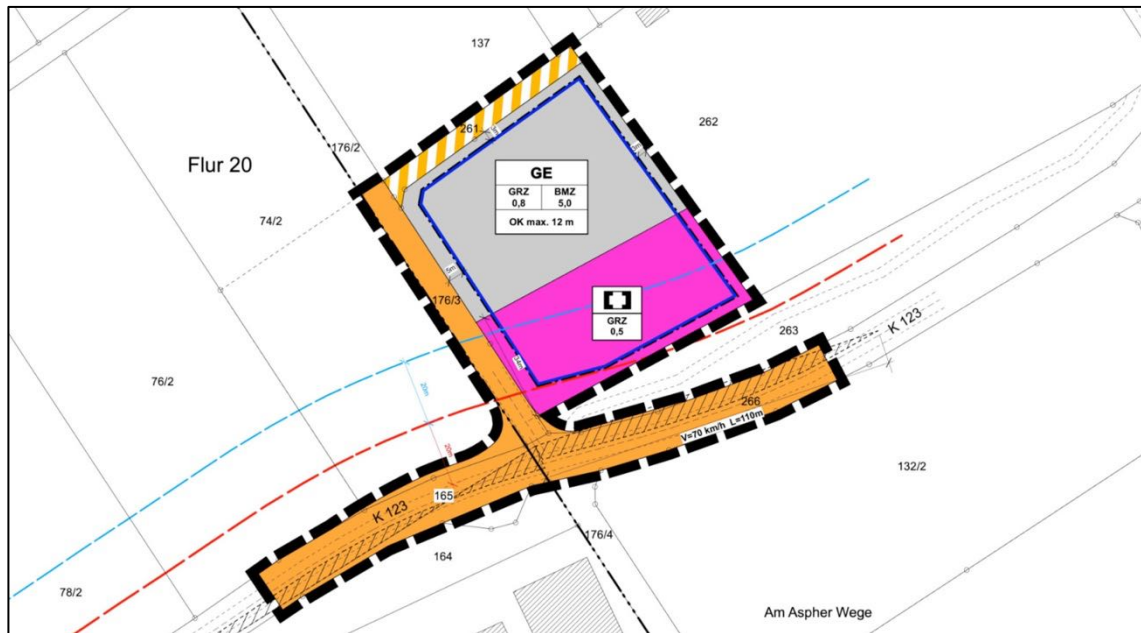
Bebauungsplan „Steinwegswiesen, 1. Änderung“ - Planteil
